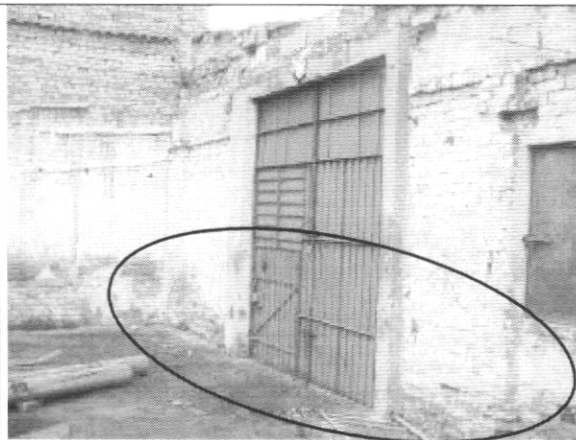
Vista interior muro de fachada, deterioro parte inferior.
